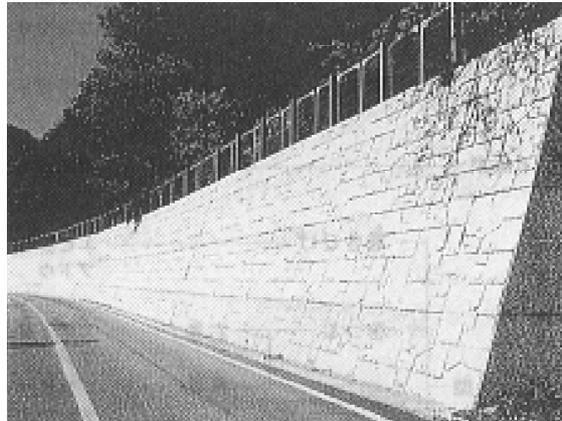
化粧型枠を用いてコンクリート壁面に擬石処理した事例
